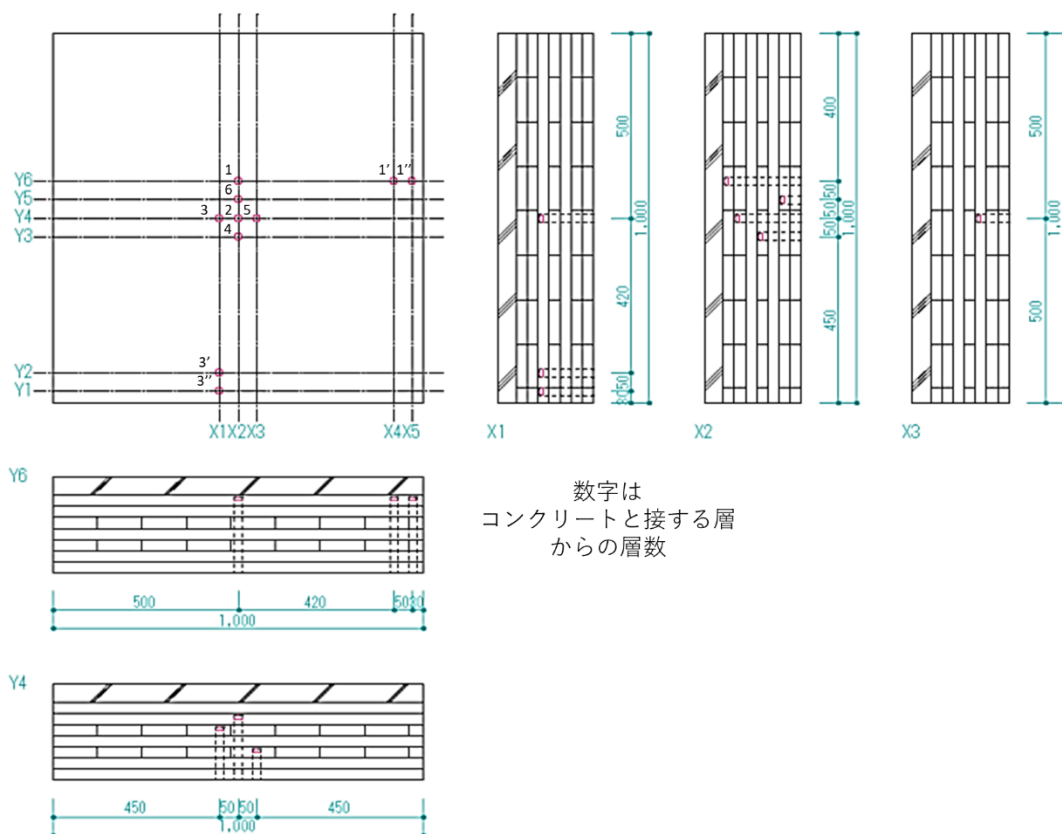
試験体 1 の温湿度センサ配置図 (平板試験体)
